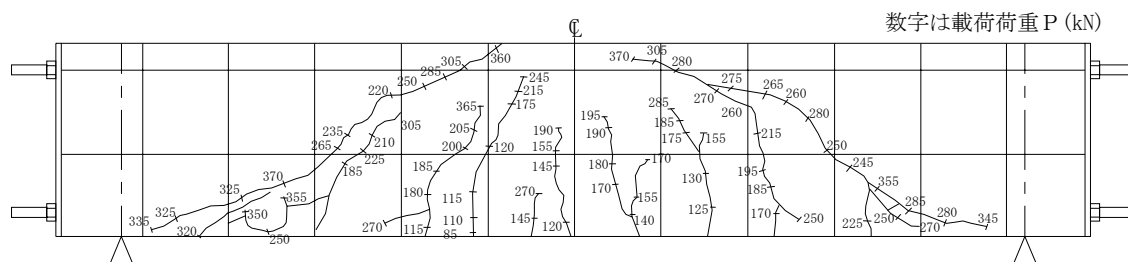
ひび割れ進展状況 (例：供試体 No. 4)
